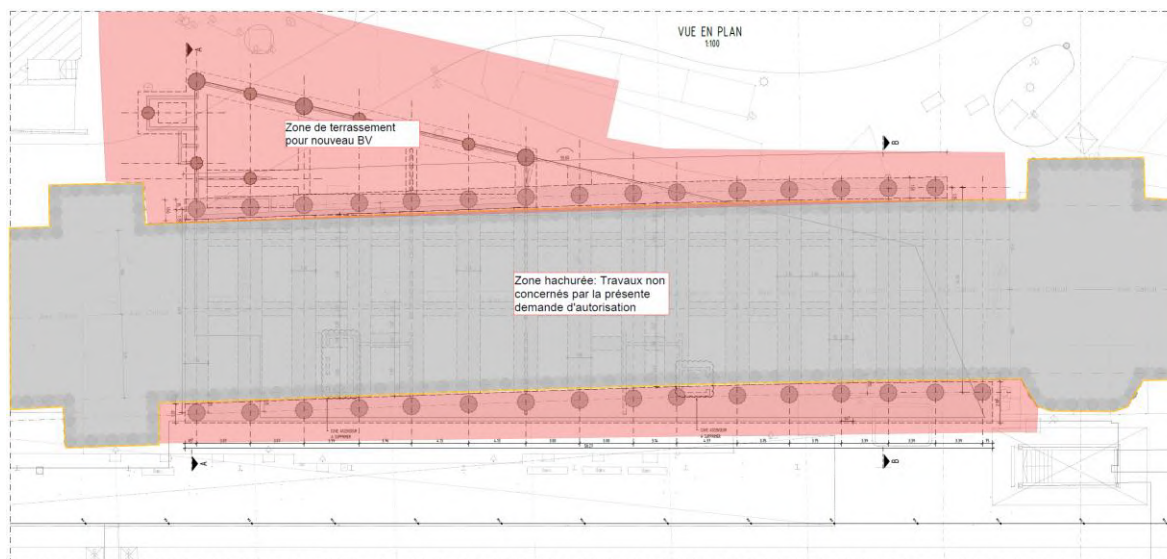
Vue en plan terrassement / fondations « bâtiment Voyageurs »
